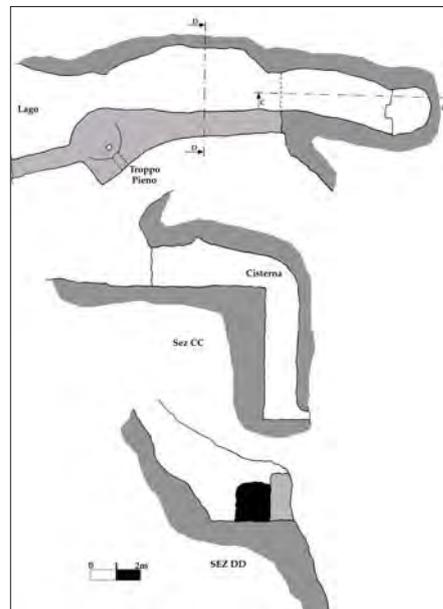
Planimetria e sezioni del lago di carico e della cisterna.
